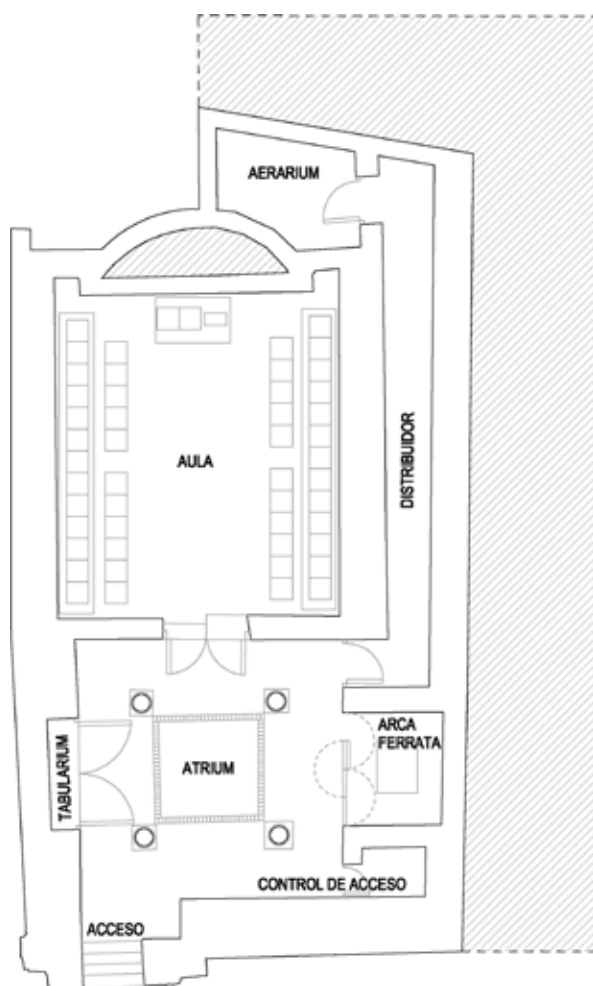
Planta Curia. Fase de uso 1. Fuente: Elaboración propia.
